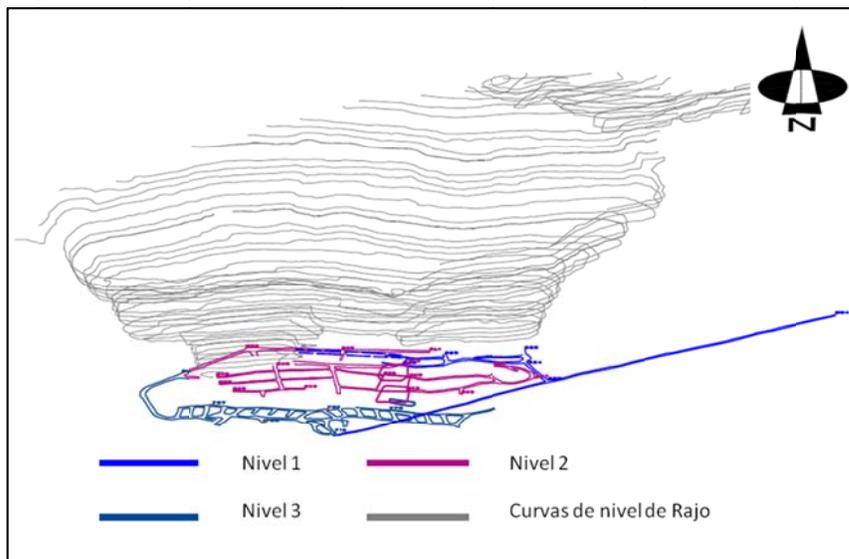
Plano esquemático de galerías subterráneas y rajo de Mina Carmen. Vista inclinada hacia el sur.
